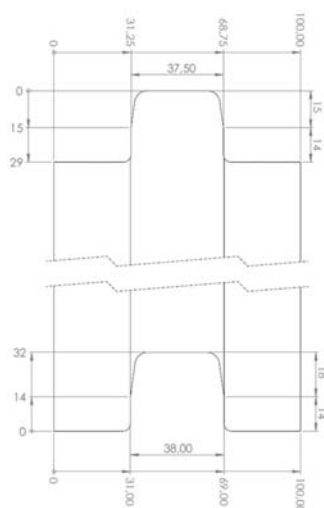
configuration de joint à rainure et languette testée (dimensions en mm) :
